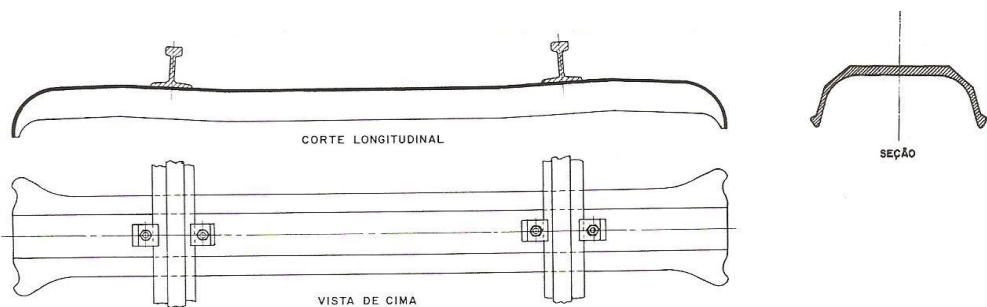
Travessa Metálica (Fonte: Brina, 1983)
